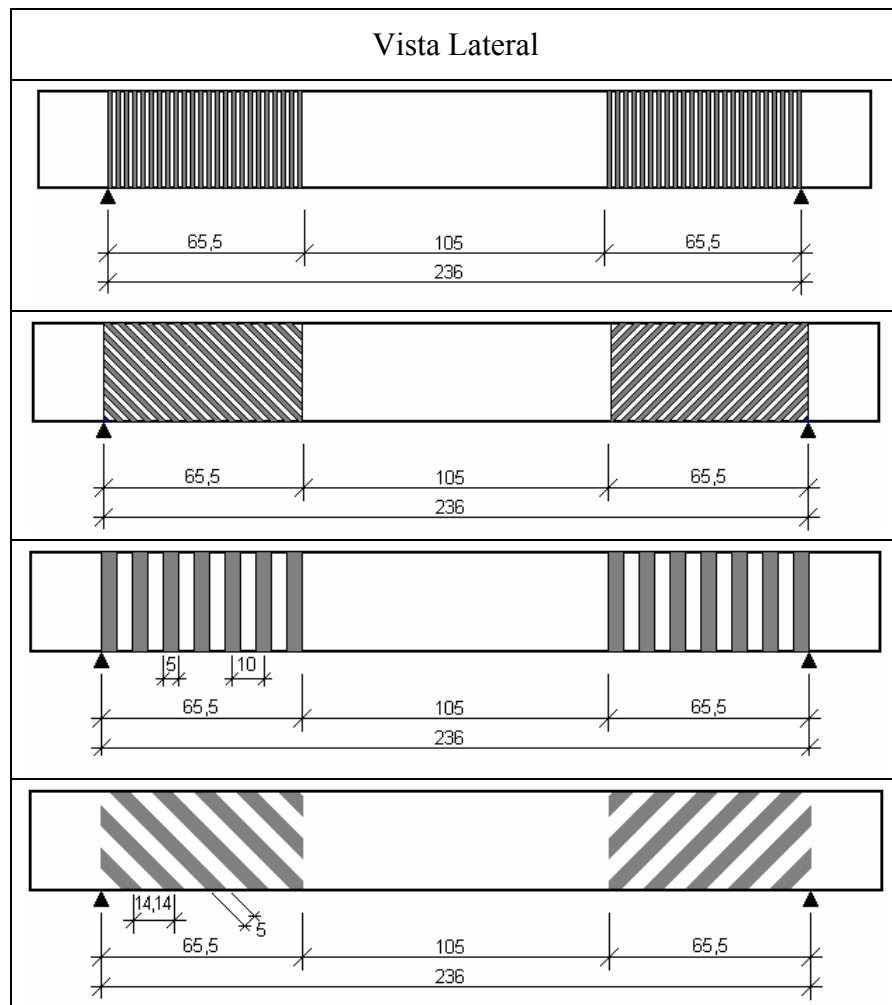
Representação esquemática das vigas reforçadas (BEBER, 2003).
